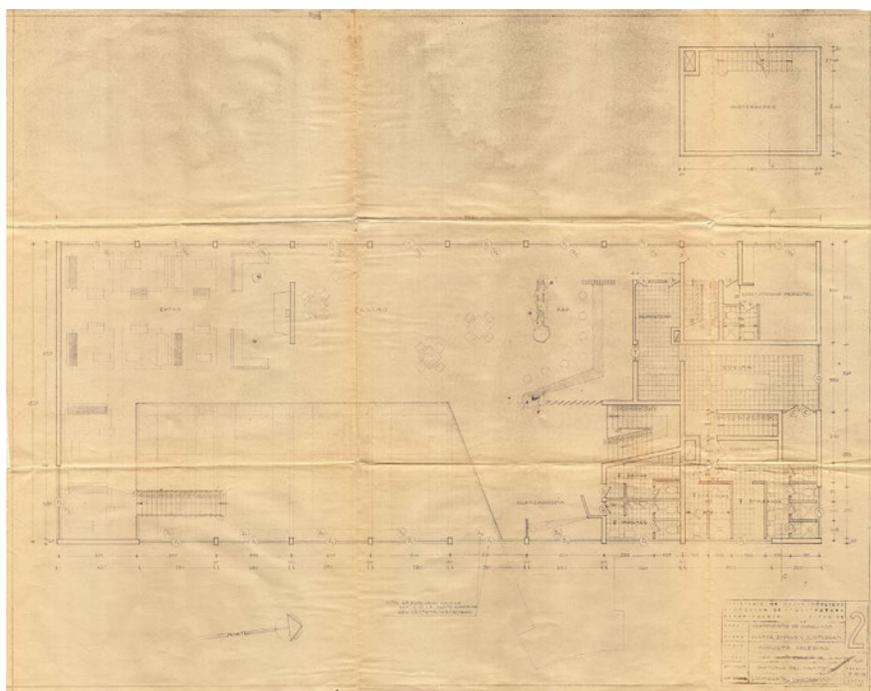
Planta 2º piso y subterráneo (fuente: Ministerio de Obras Públicas, 1956).
